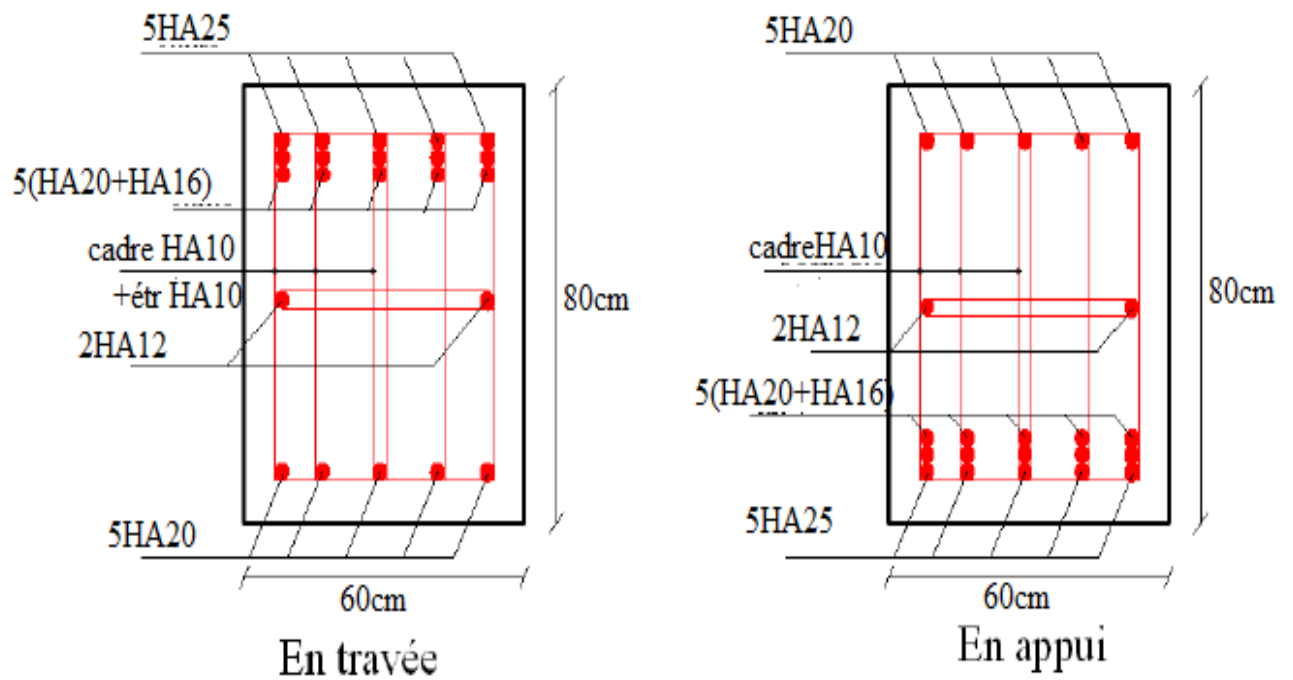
Schéma de ferrailage des nervures (x-x)
